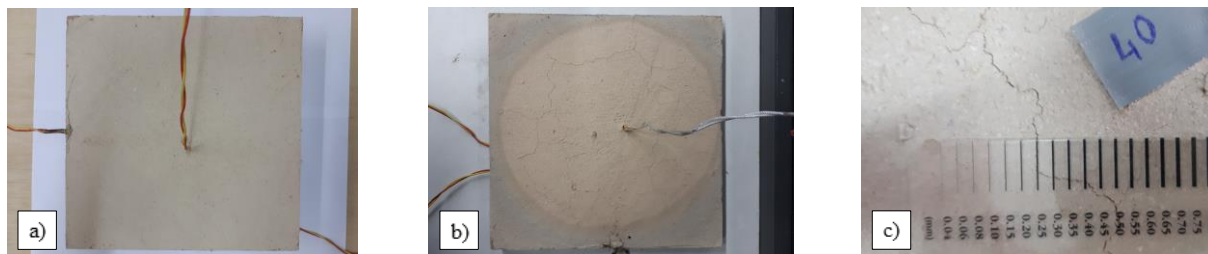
Provete P_A4_2_LA: a) Provete antes do ensaio; b) Provete após o ensaio; c) Fissuração do provete após o ensaio.
